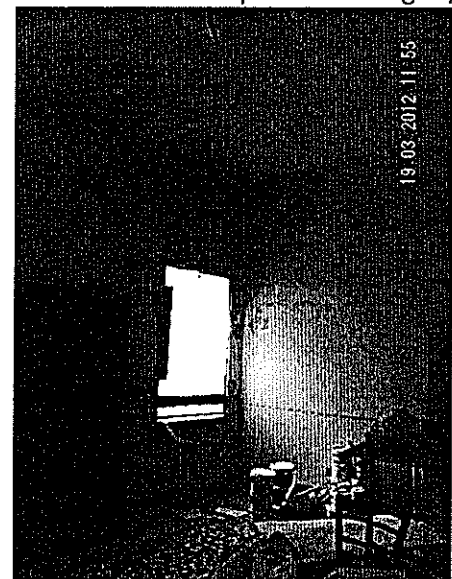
Stanza 1.6 - Vista finestra lato corte
